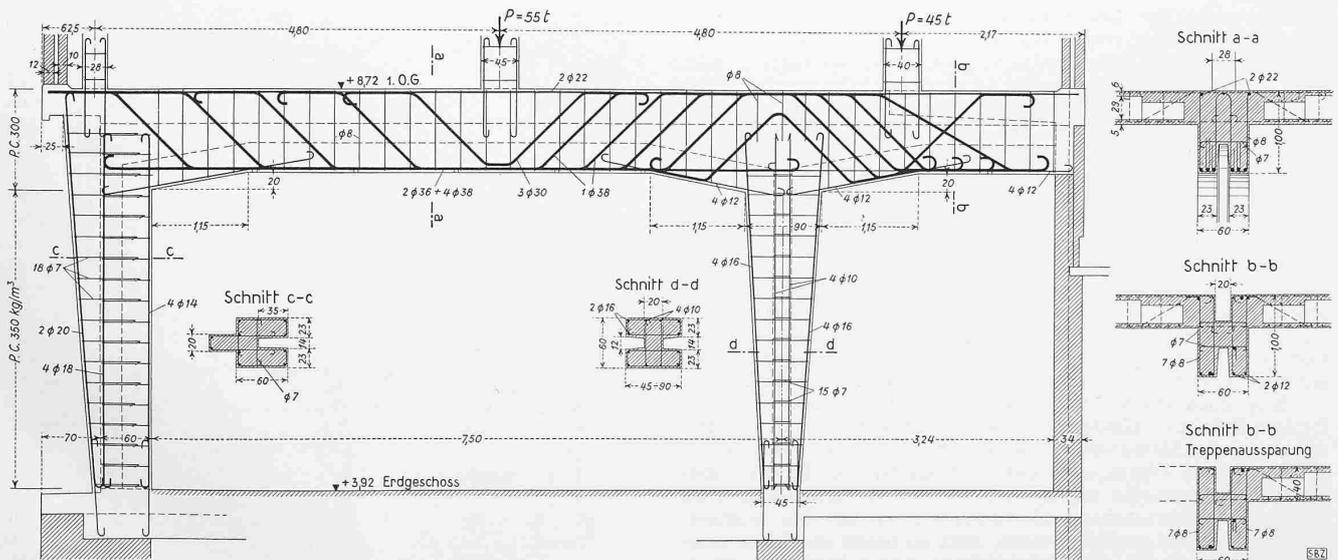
Eisenbeton-Rahmenbinder der Ausstellungshalle. — Dipl. Ing. ADOLF BRUNNER, St. Gallen. — Masstab 1 : 80
